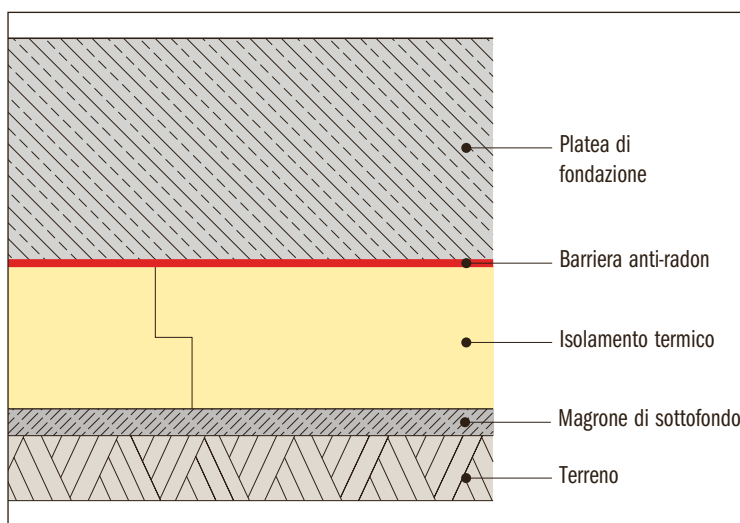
Protezione radon e isolamento termico sotto la platea di fondazione (Fonte: Dow Building Solutions).
